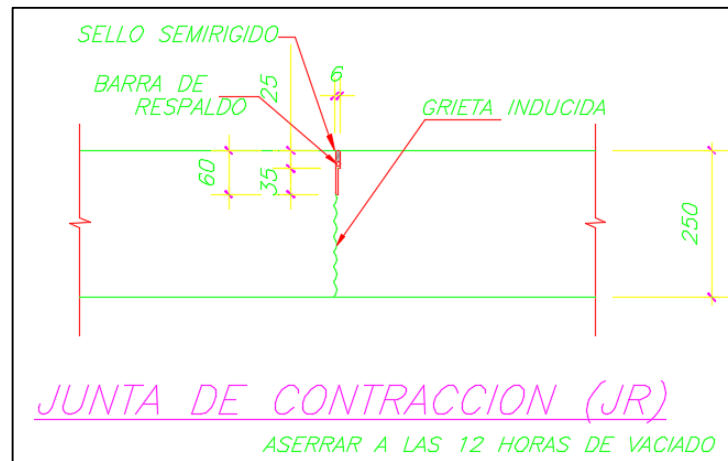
Detalle de junta de contracción según indicación de planos.
